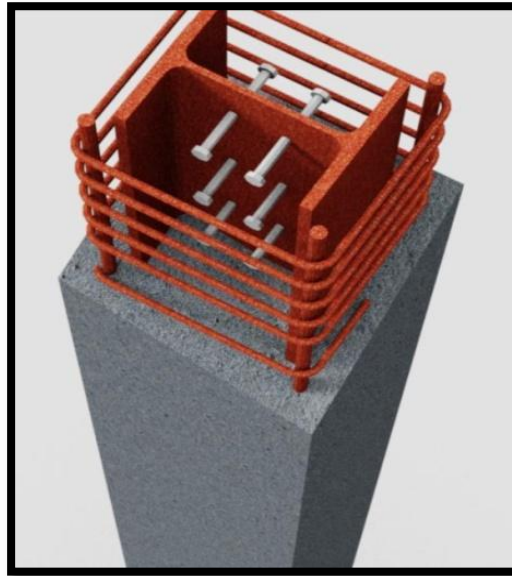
Schéma d'un poteau mixte ¹⁵⁷
